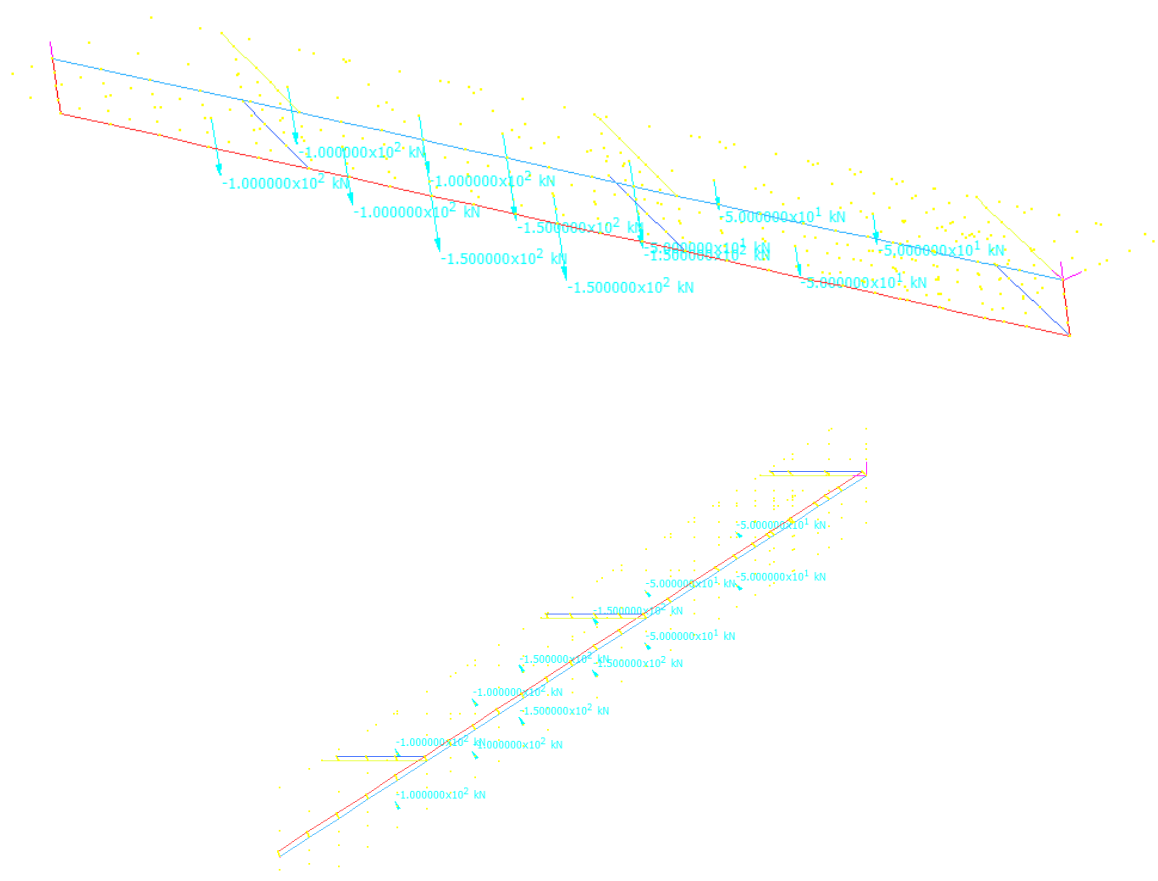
Modello tridimensionale del traverso di spalla isolato. Vista 3D e planimetria della disposizione dei carichi
